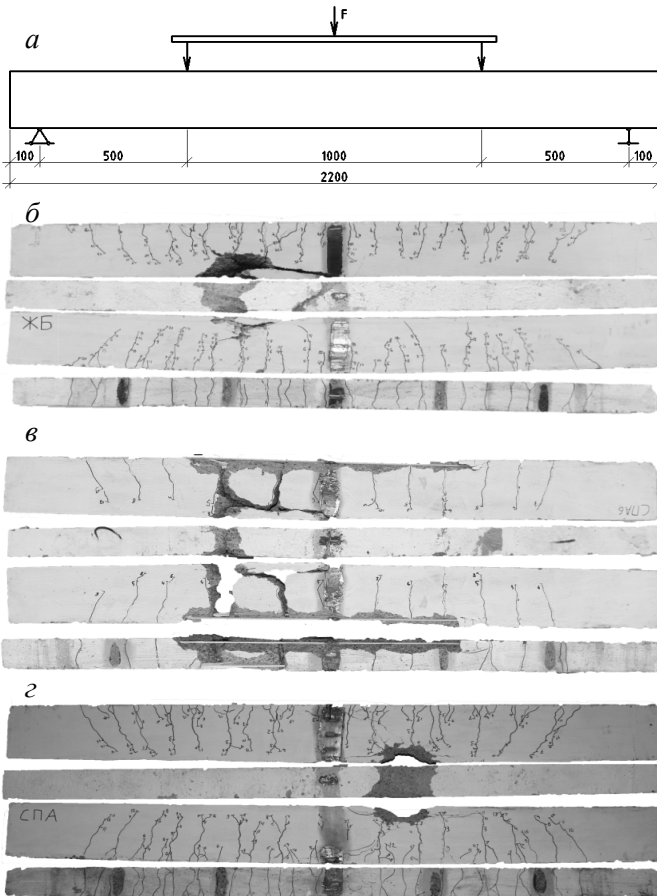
Испытание изгибаемых элементов статической нагрузкой: схема испытания (а); характерные схемы разрушения и трещинообразования изгибаемых элементов, армированных стальными (б), стеклопластиковыми $\varnothing 6$ (в) и $\varnothing 10$ (з) стержнями
